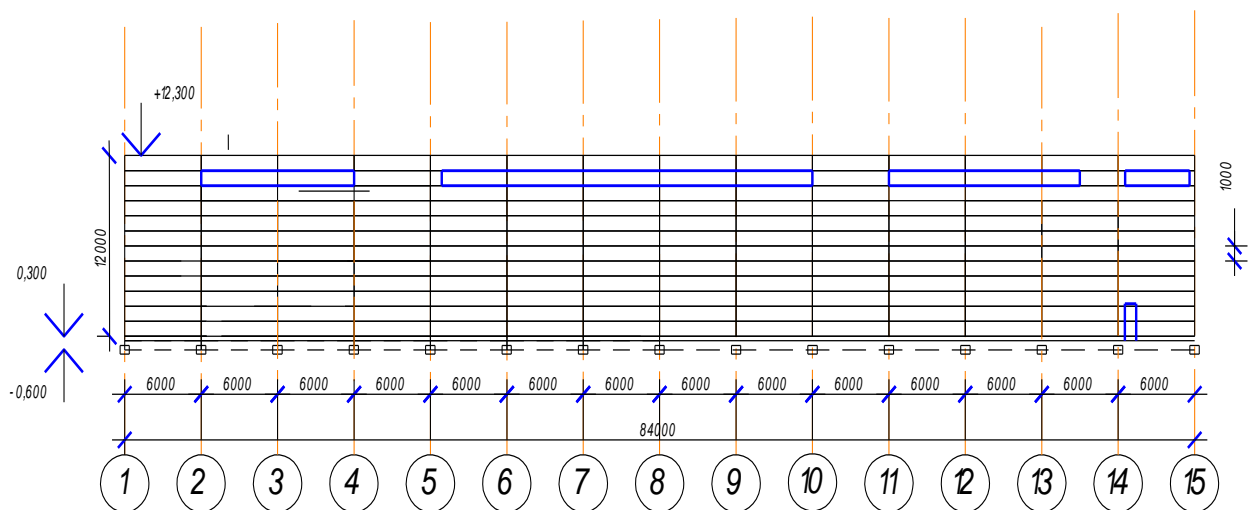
Схема расположения стеновых панелей в боковых фасадах здания
